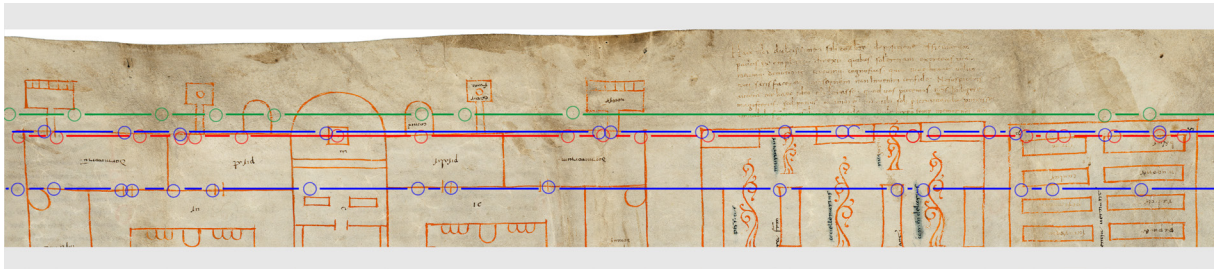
Einstichmarkierungen in die östliche Planhorizontale
